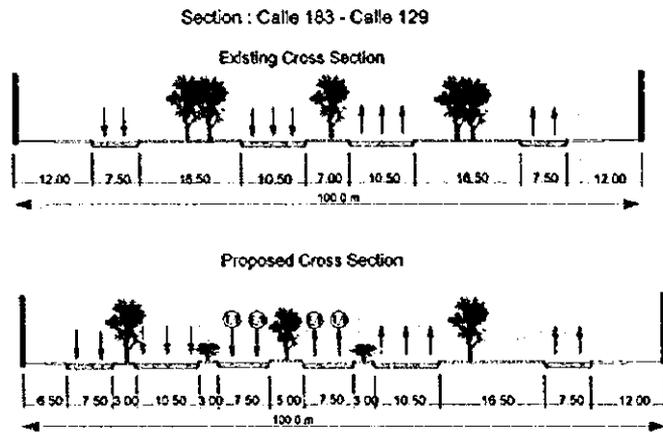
Sección Típica sobre Autopista Norte (2)
